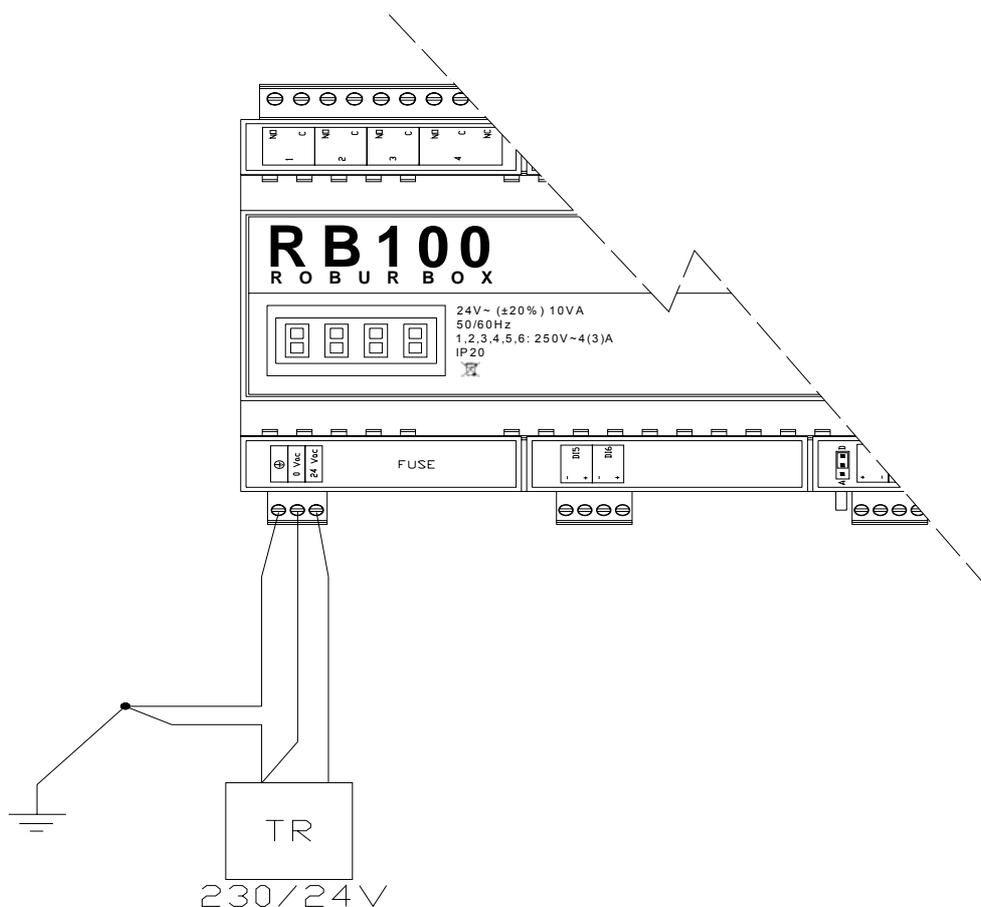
RB100. Esempio di collegamento alla rete: alimentazione elettrica 24 Vac 10VA
